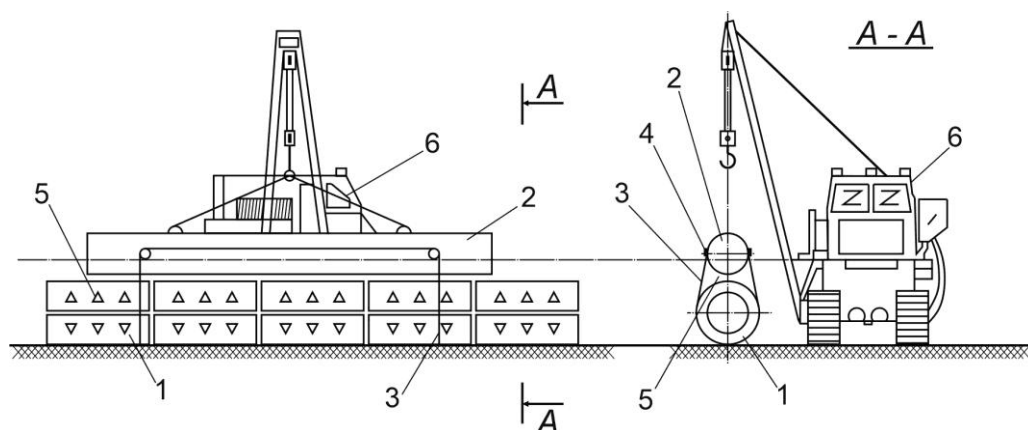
Схема навішування розвантажувальних понтонів на трубопровід: 1 – трубопровід, що укладається; 2 – понтон; 3 – строп; 4 – клини; 5 – дерев'яні прокладки; 6 – трубоукладач
